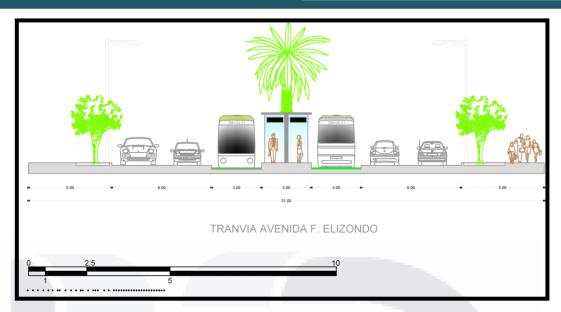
Sección transversal de la propuesta de adecuación para la Avenida José F. Elizondo
